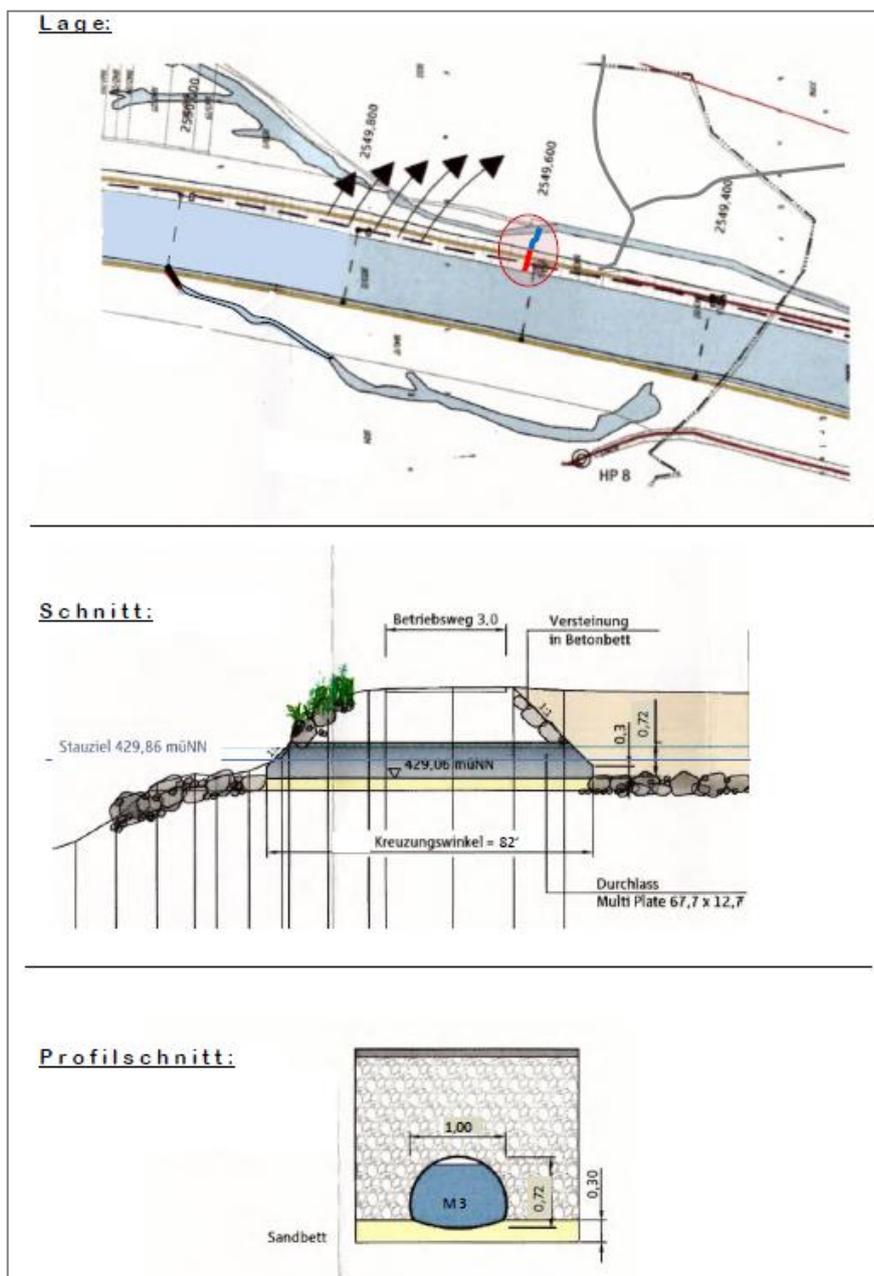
Ausschnitt aus dem Ausführungsplan der Rohranbindung
